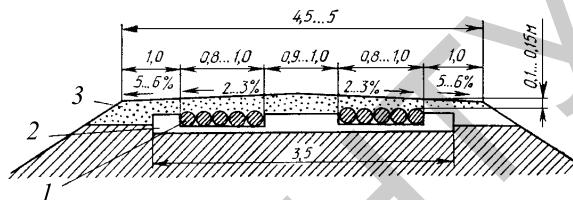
Деревянно-грунтовое колейное покрытие:
